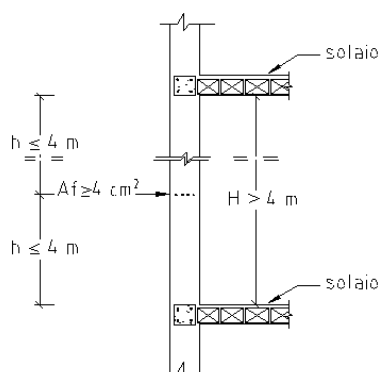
Armatura orizzontale supplementare (caso $H > 4.00$ m) (12)
